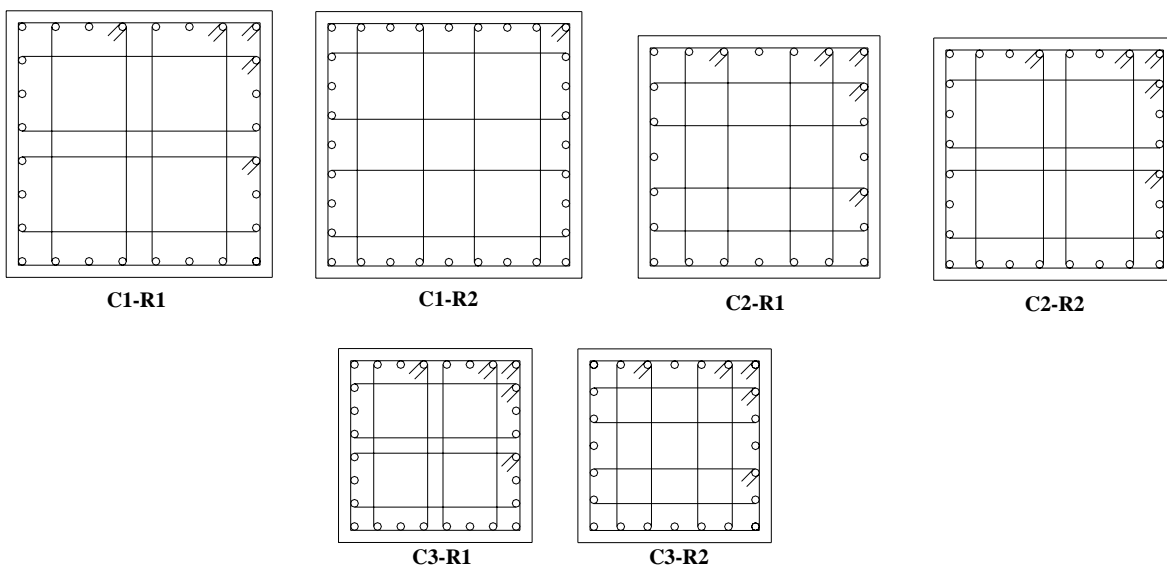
Secciones y refuerzos de las columnas del modelo M2Q4AA
